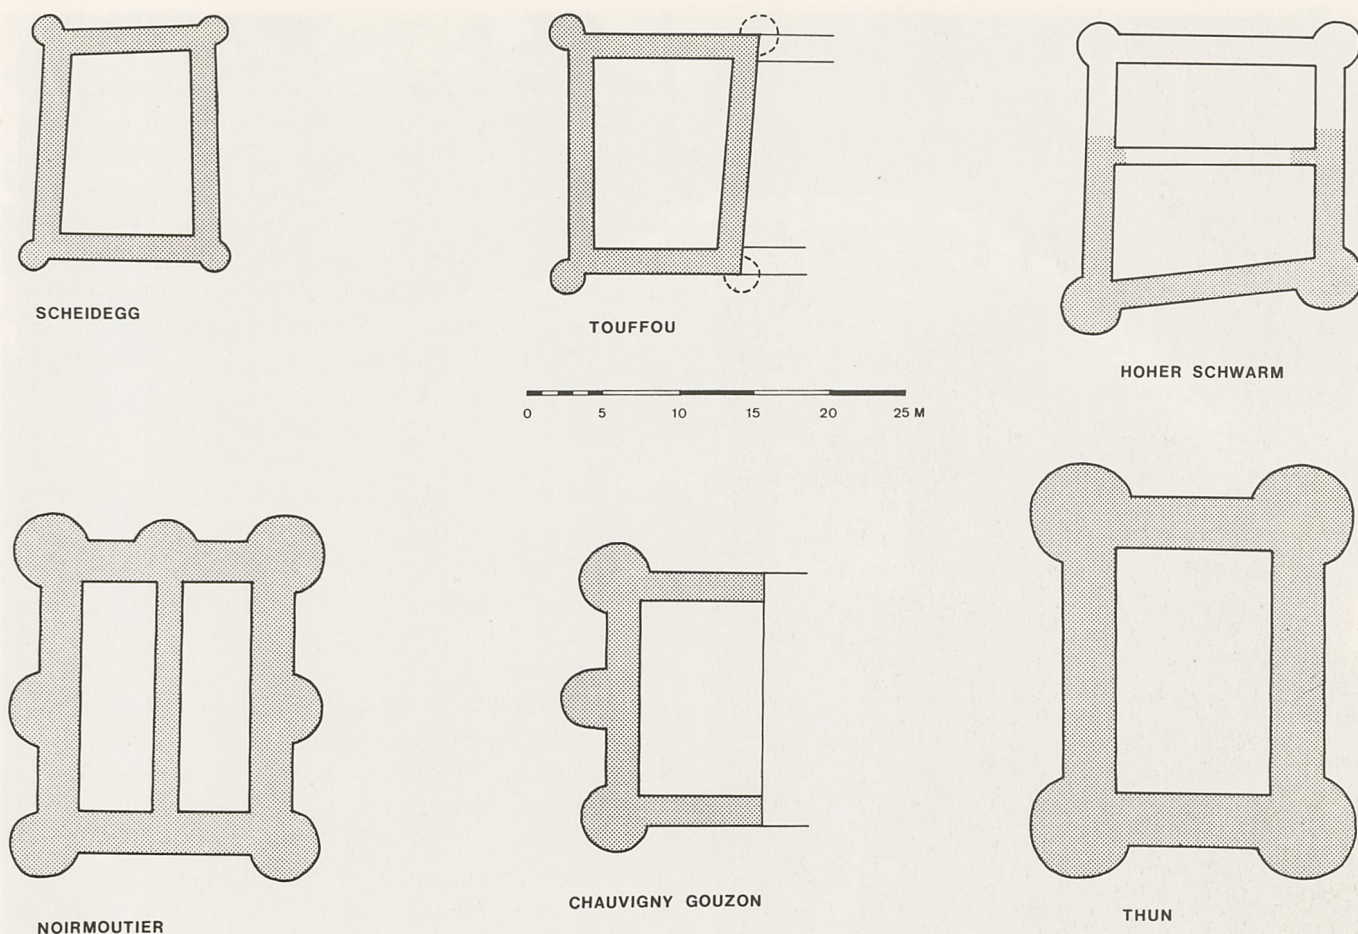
Verschiedene Donjon-Grundrisse, zu Vergleichszwecken nebeneinander gestellt.
